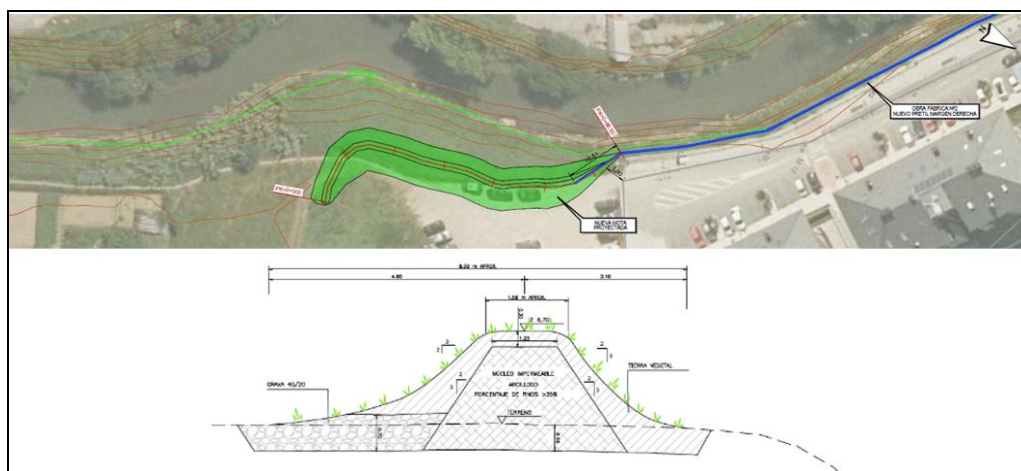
Mota proyectada en terrenos de Ajangiz (Fuente: LKS)
